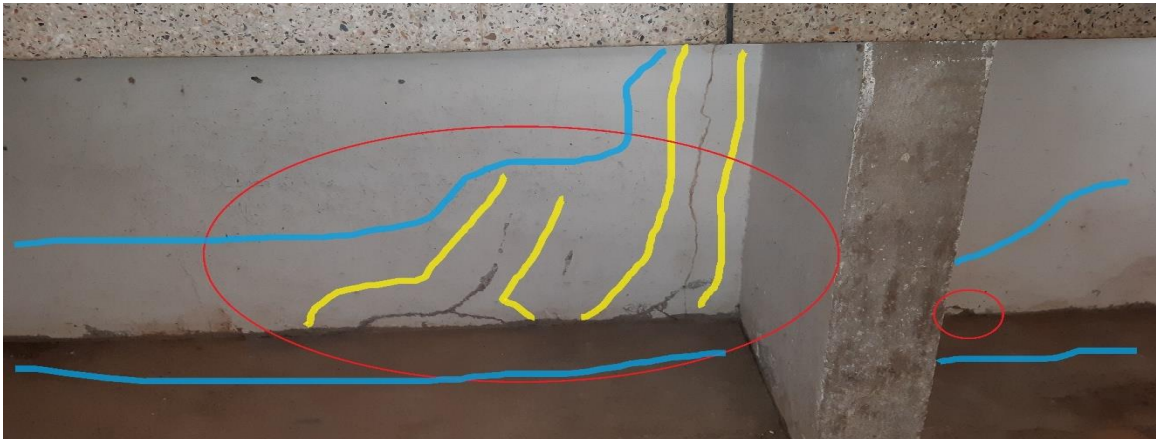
Evidencia de fisuras, grietas, fracturas y humedades en muros con y sin revestimientos.
